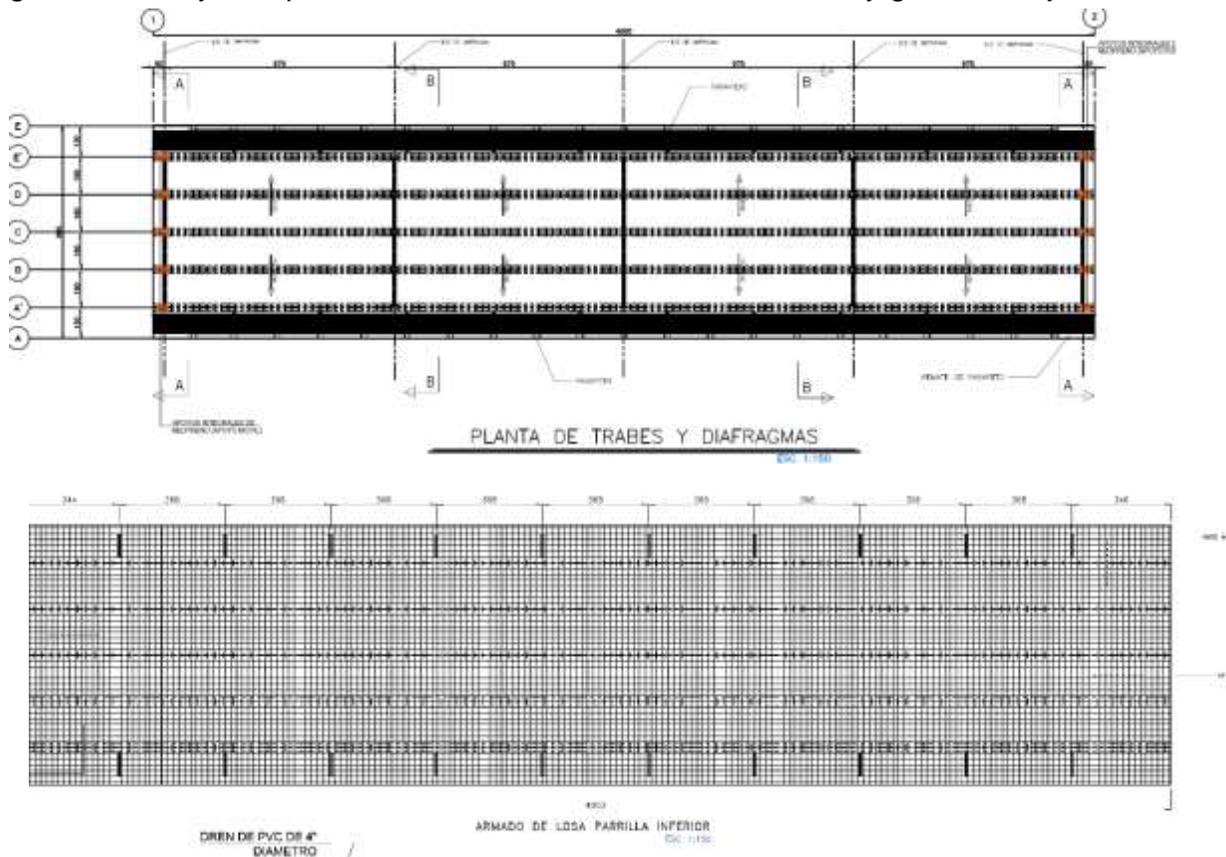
Vista de planta de traveses y diafragmas, así como del armado de la losa
